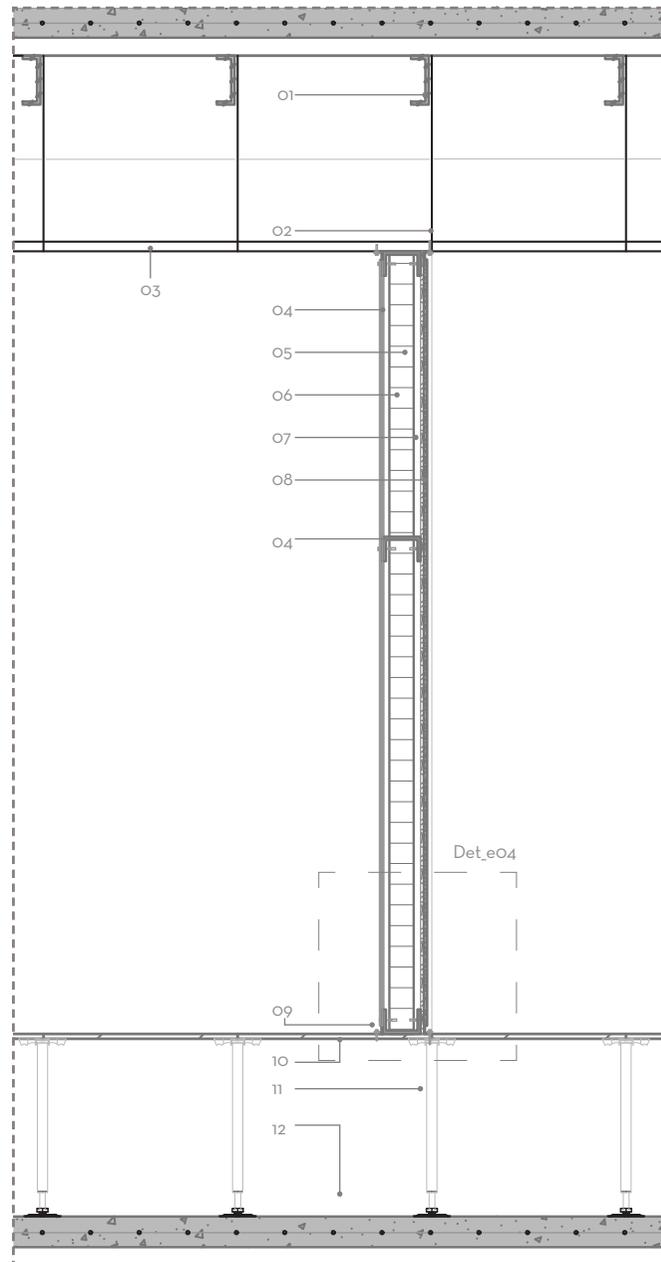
Det_03 Escantillón de anclaje para paneles en envolvente piso técnico.
